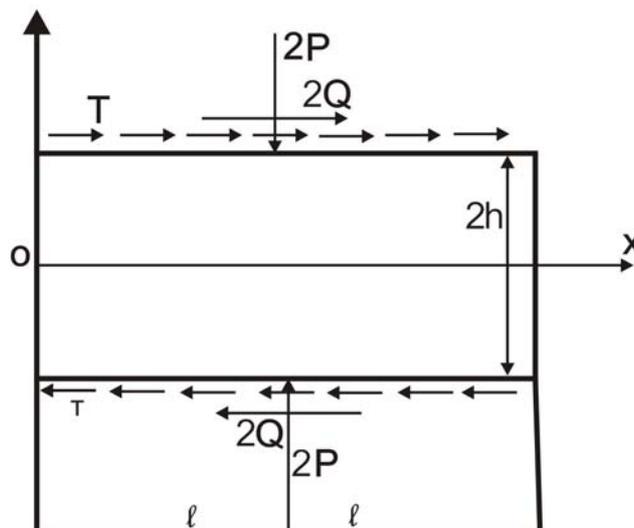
Схема нагружения податливой породожелезобетонной конструкции
